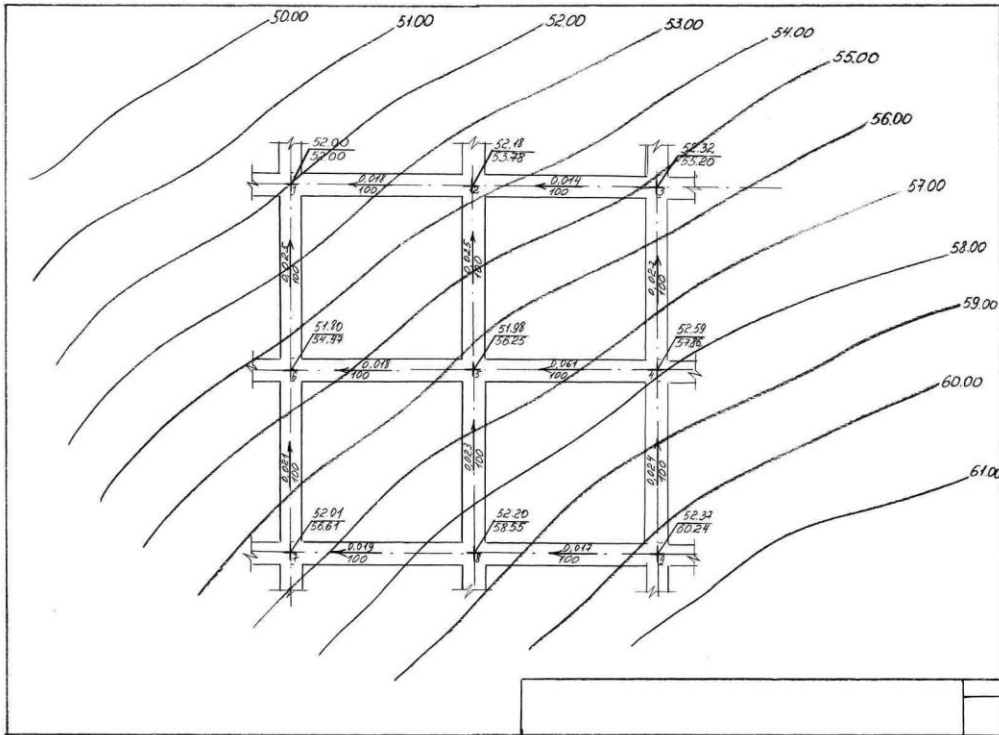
Образец чертежа подосновы фрагмента планировки поселения
